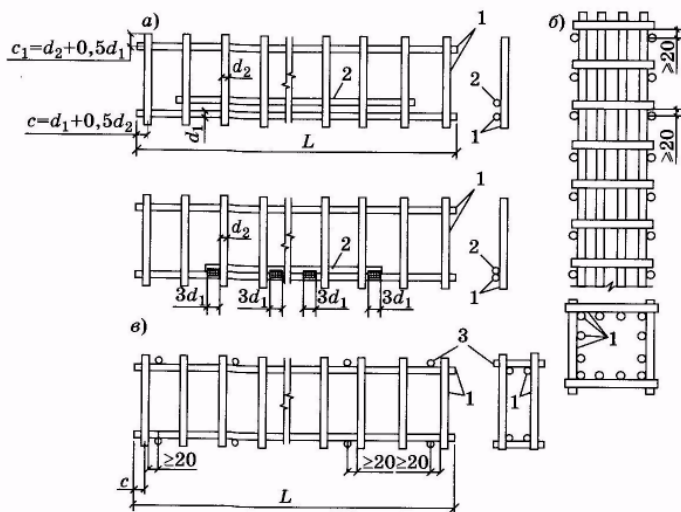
Сварные каркасы: *a* - плоские; *б* - пространственный, образованный из плоских каркасов; *в* - то же, образованный из плоских каркасов с применением соединительных стержней; 1 - продольные и поперечные стержни плоских каркасов; 2 - дополнительные продольные стержни; 3 - соединительные стержни пространственного каркаса
